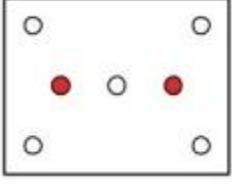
Plan de chevillage complémentaire pour finition par plaquettes en terre cuite
